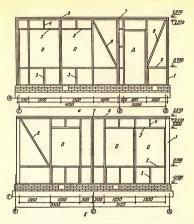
Конструкция каркасов наружных стен вдоль осей A(a) и 1(6): 1, 3 н 4 — угловая, подоконная н надоконная стойки; 2 н 5 — подоконный и надоконный ригали; 6 н 7 — стыки брусков 2-го и 1-го ряда верхией обвлажи; 8 — подкос; 0 — оконный проем; д — дверной проем
